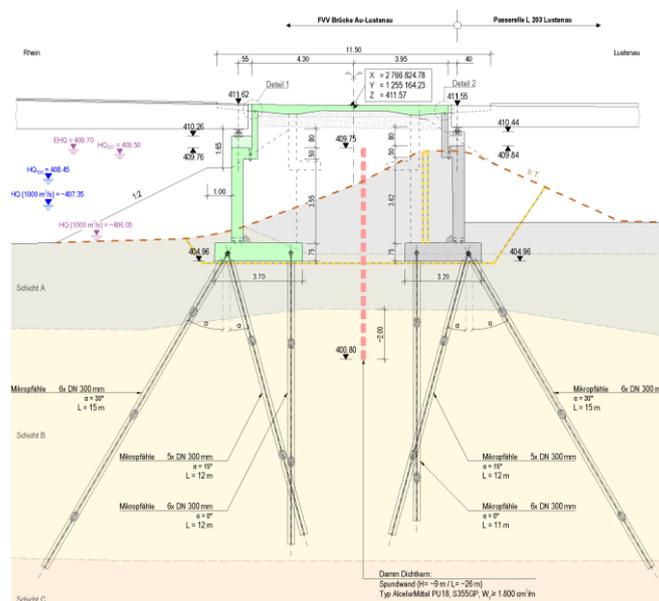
FVV Brücke: Widerlager Lustenau Schnitt
